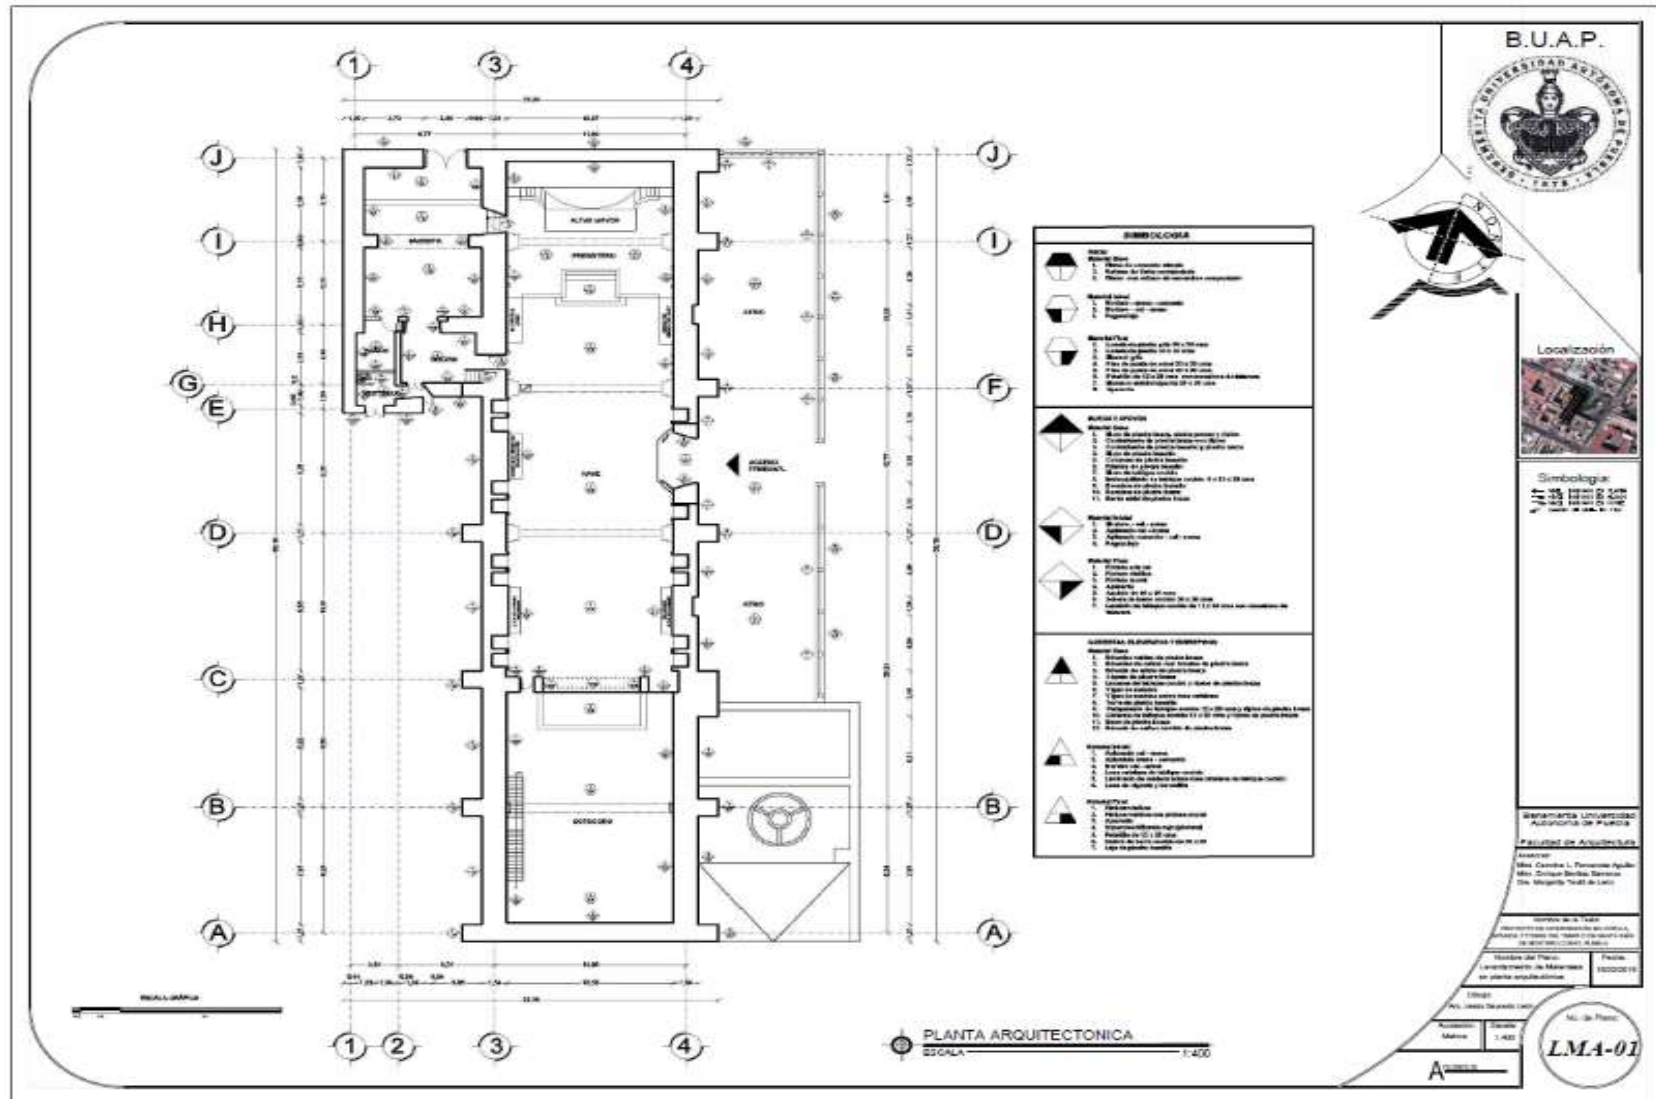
LMA-01. Levantamiento de materiales y sistemas constructivos del Templo de Santa Inés.
